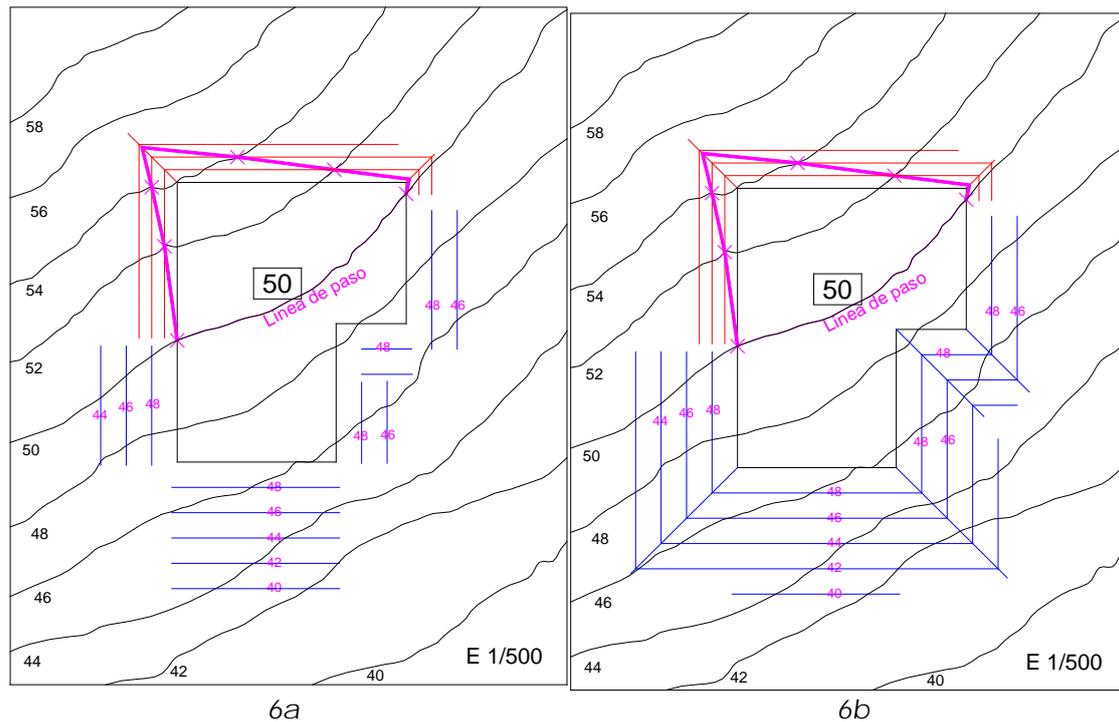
Trazado de los planos de terraplén (6a) y de las intersecciones entre los mismos (6b)
